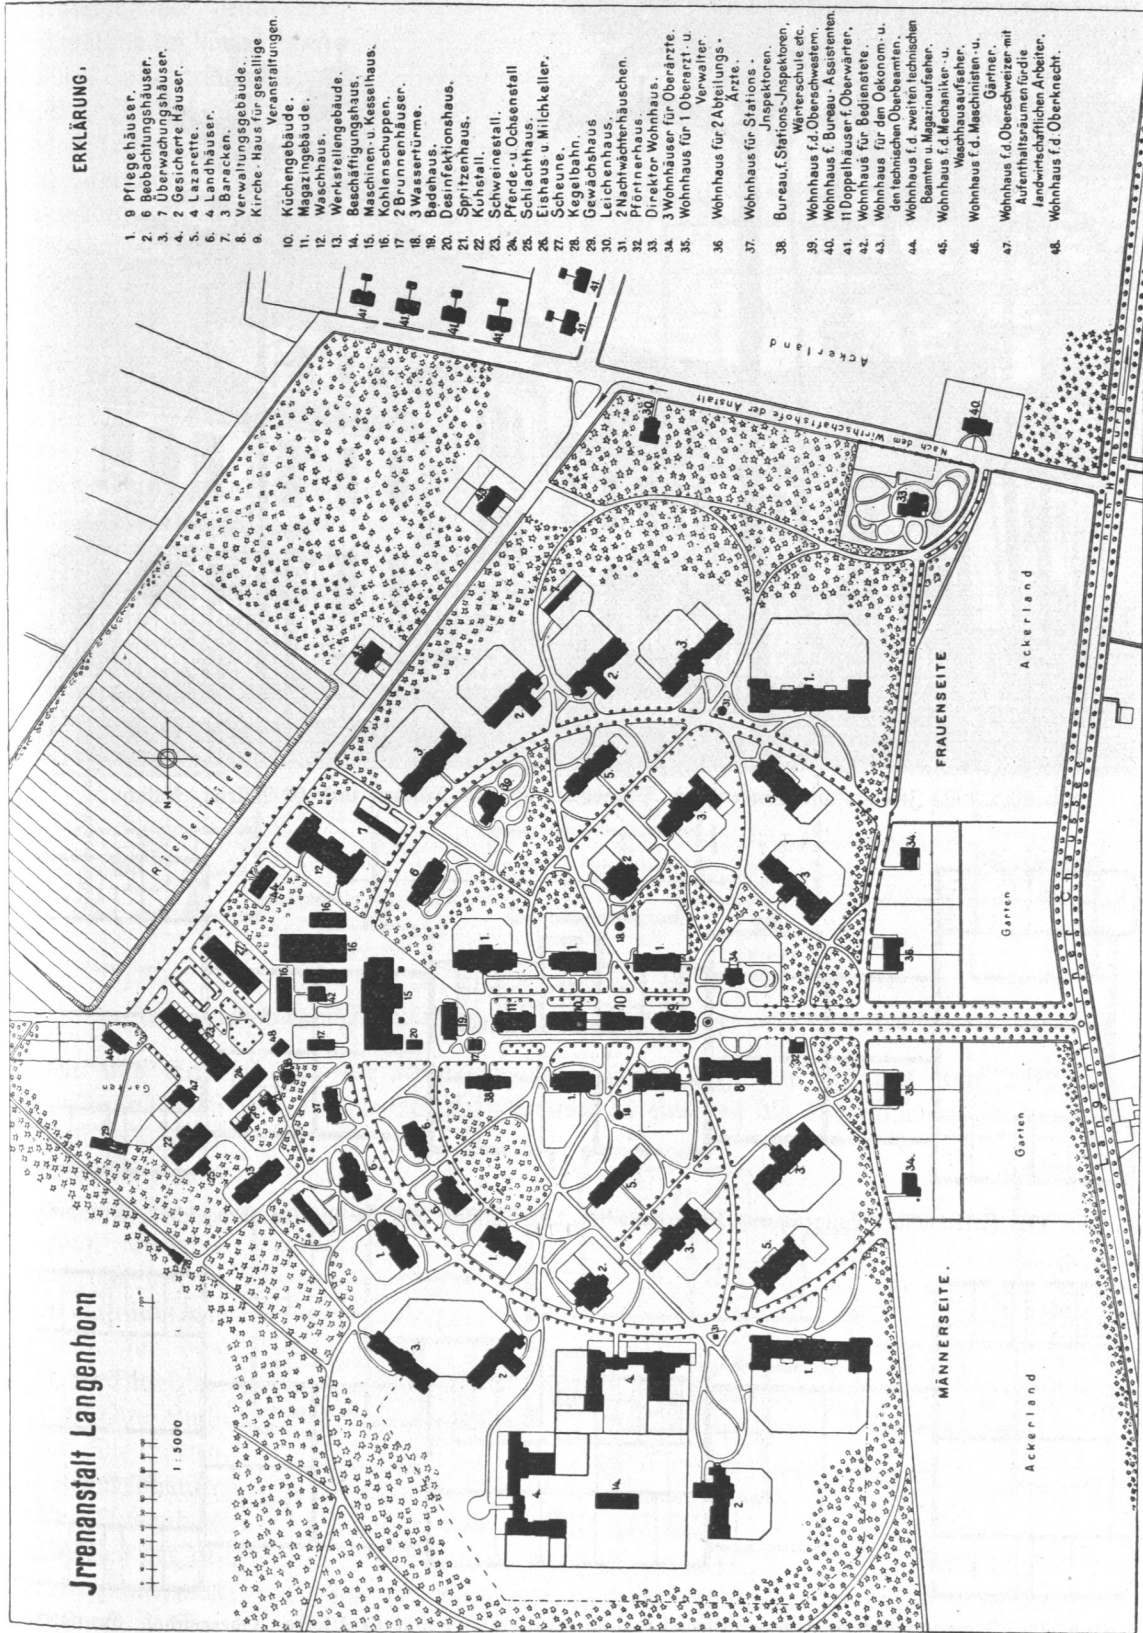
Lageplan der Irrenanstalt Langenhorn.
